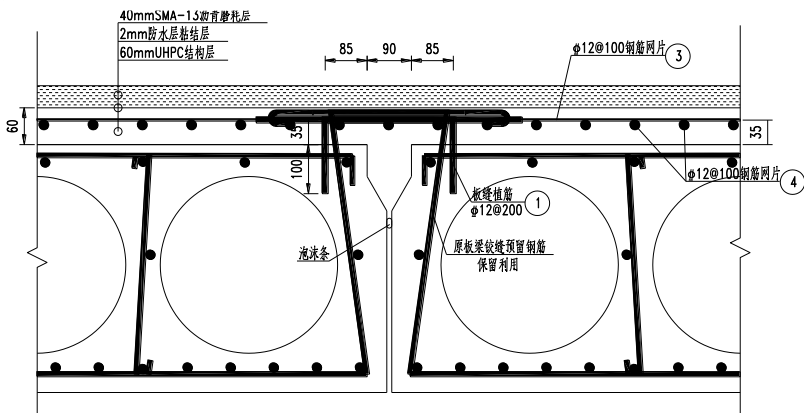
超高性能混凝土用于空心板梁铰缝及结构加固示意图
